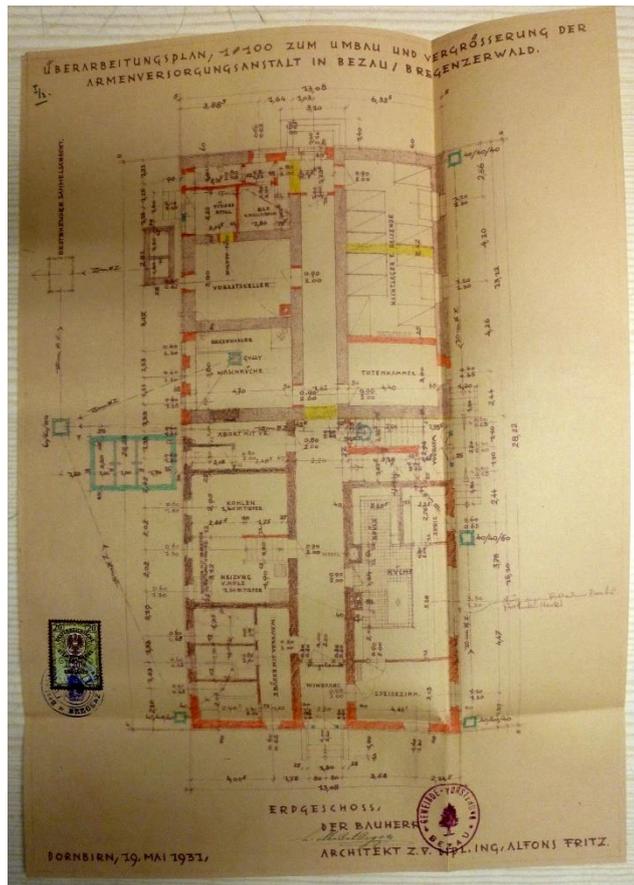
Alfons Fritz, Umbau und Vergrößerung der Armenversorgungsanstalt, Bezau, Grundriss Erdgeschoss 1:100, 19.05.1931
